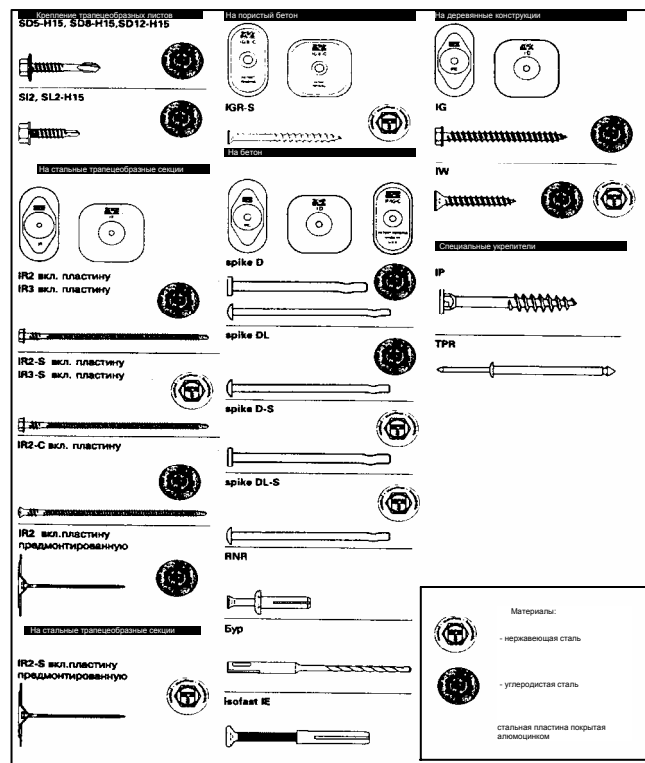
Детали для механического крепления кровельной полимерной пленки и теплоизоляции
